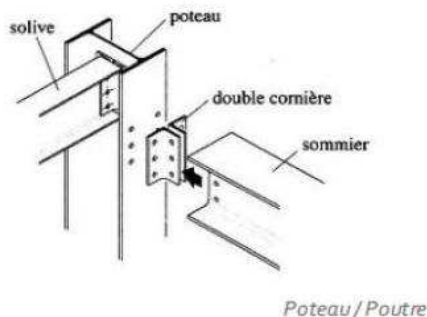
Schéma représentatif de l'assemblage poteau -poutre Source : www.google image.fr
